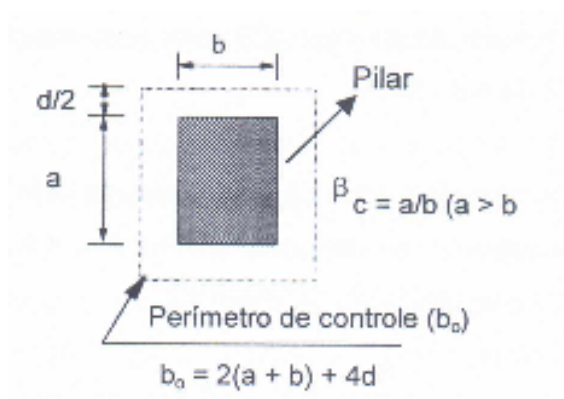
perímetro crítico de acordo com o ACI – 318/95 (AMERICAN BUILDING CODE REQUIREMENTS FOR REINFORCED CONCRETE, 1995 apud TRAUTWEIN, 2001)
